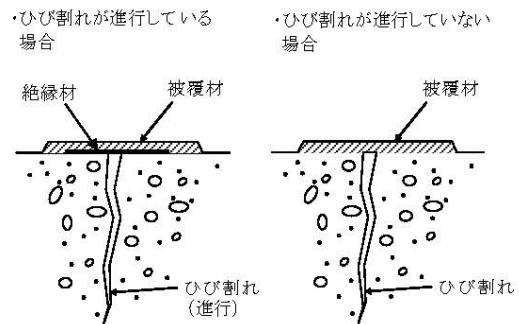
各ひび割れ補修工法の選定例²⁾
